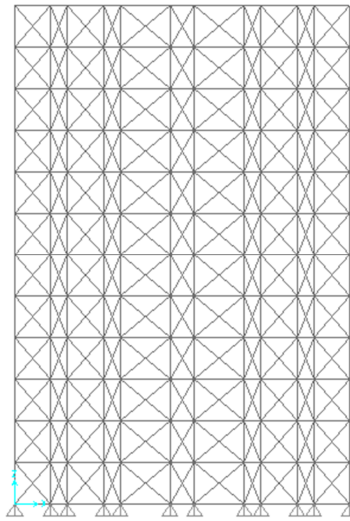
Configuração dos Planos de Contraventamento Vertical Com Elementos de Contraventamento Pequenos
